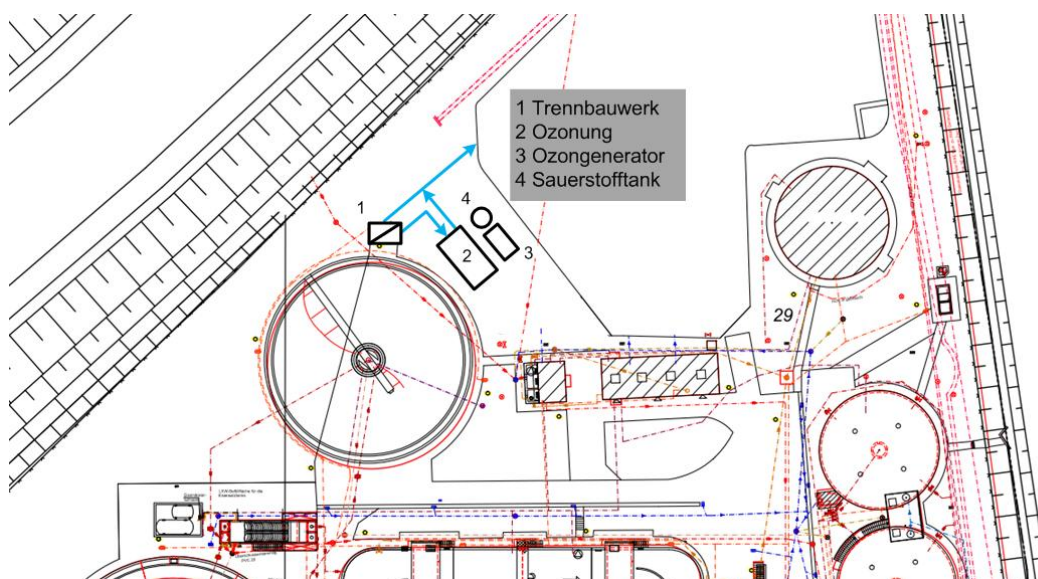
Lageplan der Ozonung auf der Münster-Geist
